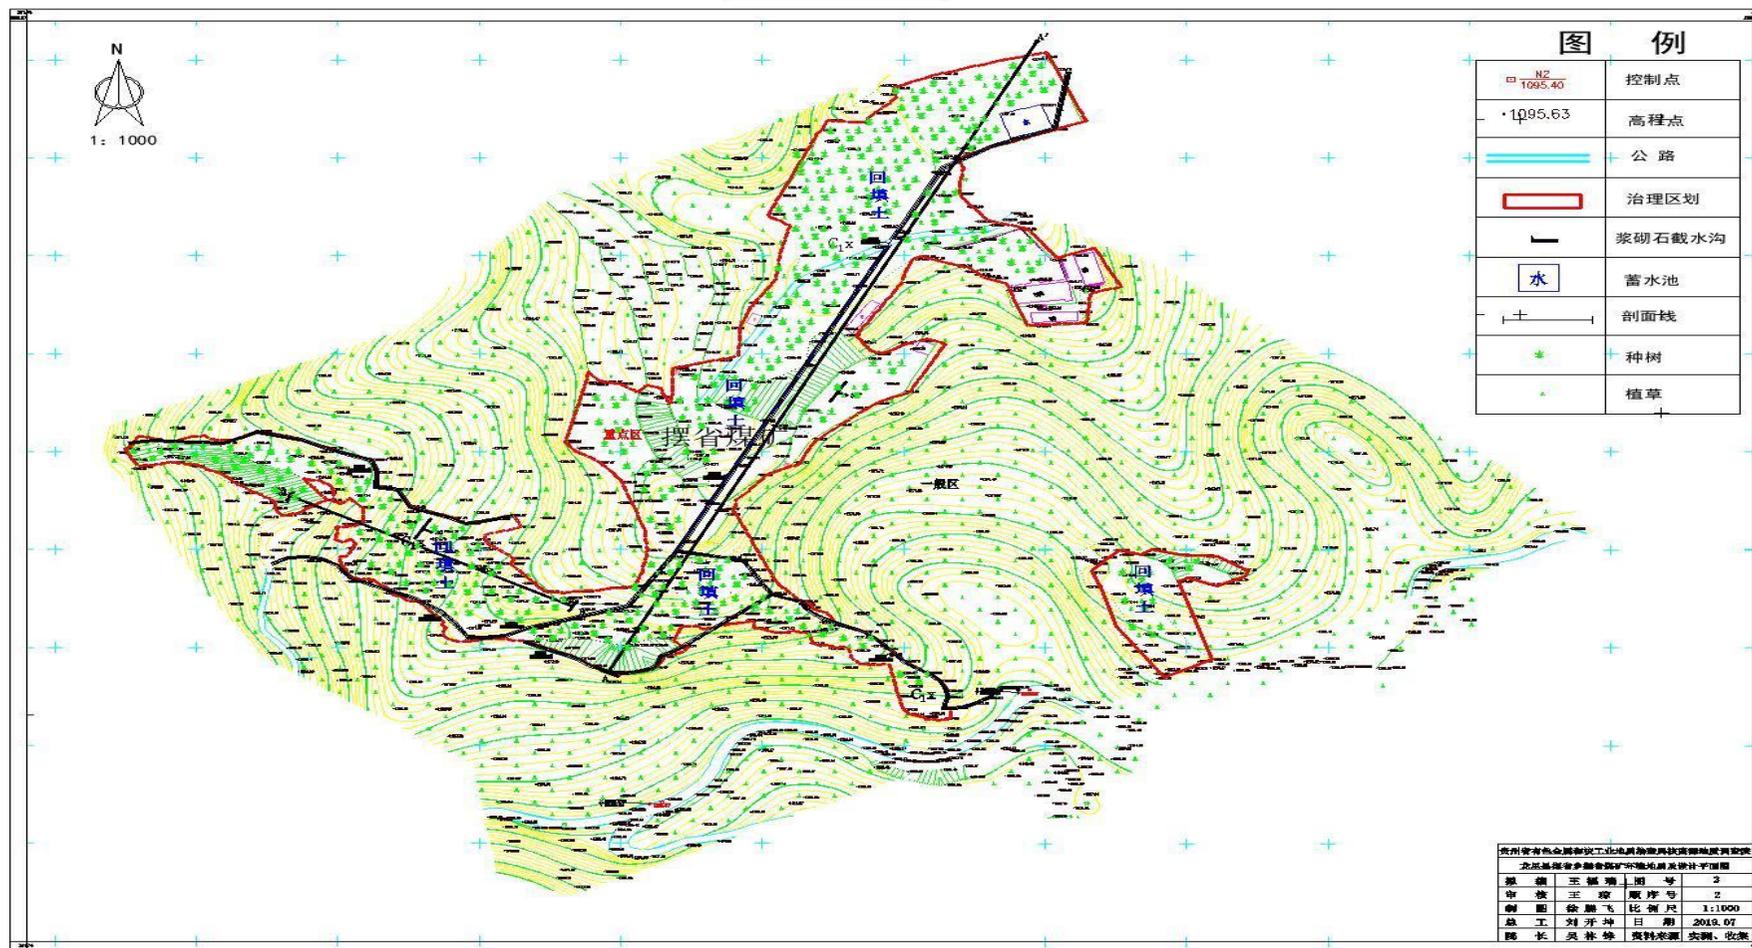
贵州龙里摆省煤矿环境地质及复绿工程设计平面图
